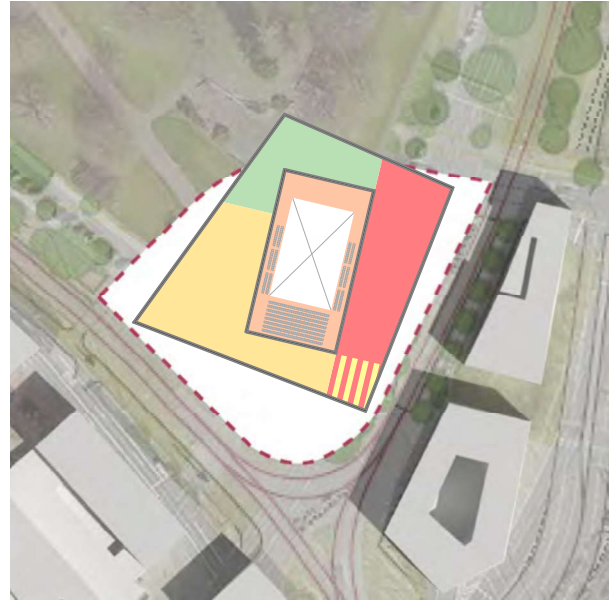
Grundriss OG1 Bahnhofsquartier V1
